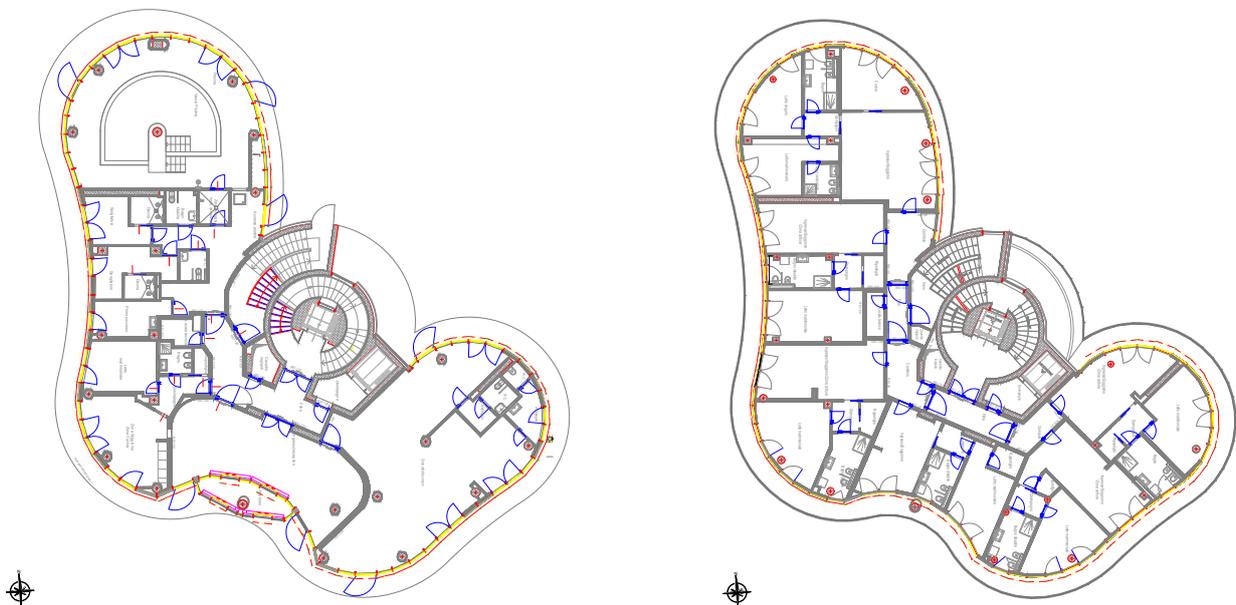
Piante del piano terra (sx) e del primo piano (dx) in sezione dell’edificio in esame
